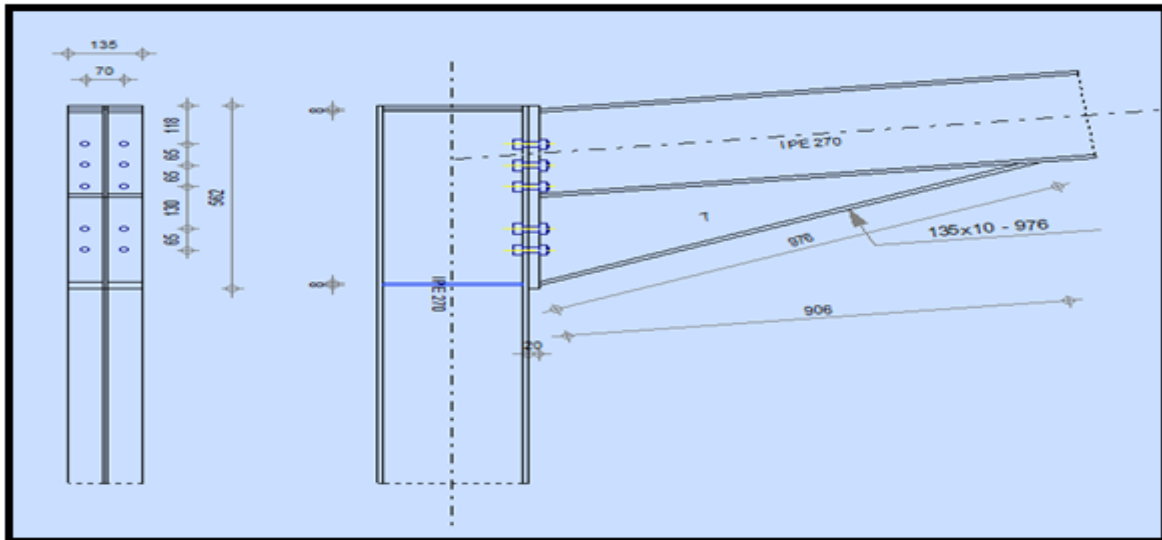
Vue en plan de l'assemblage poteau-traverse
